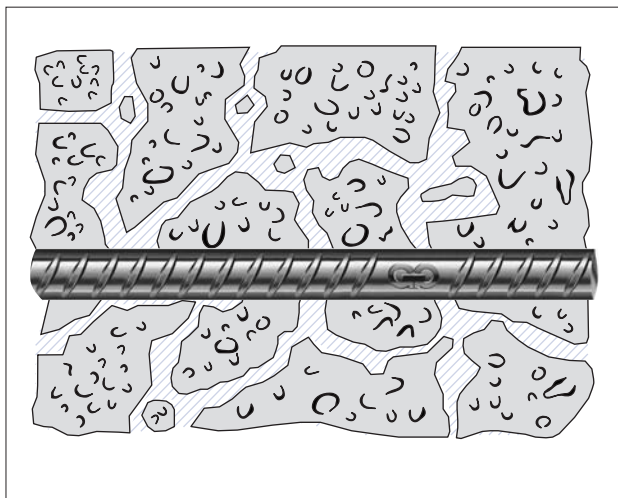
Red Poros Capilares en la Fase Acuosa del Hormigón
